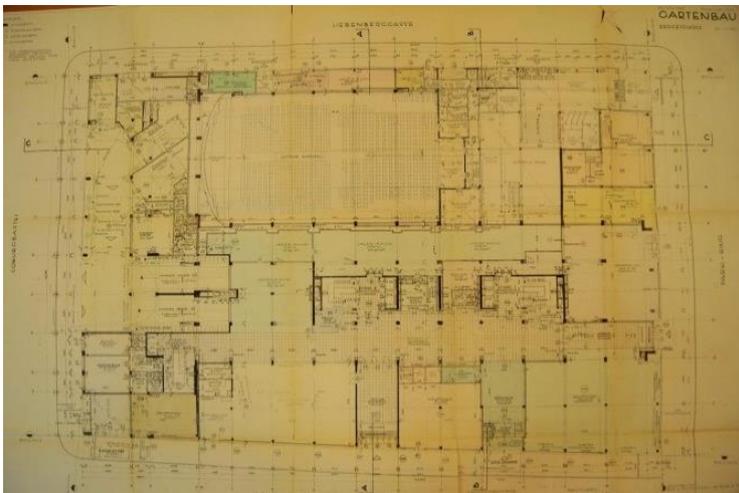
Gartenbaugebäude, Grundriss,
